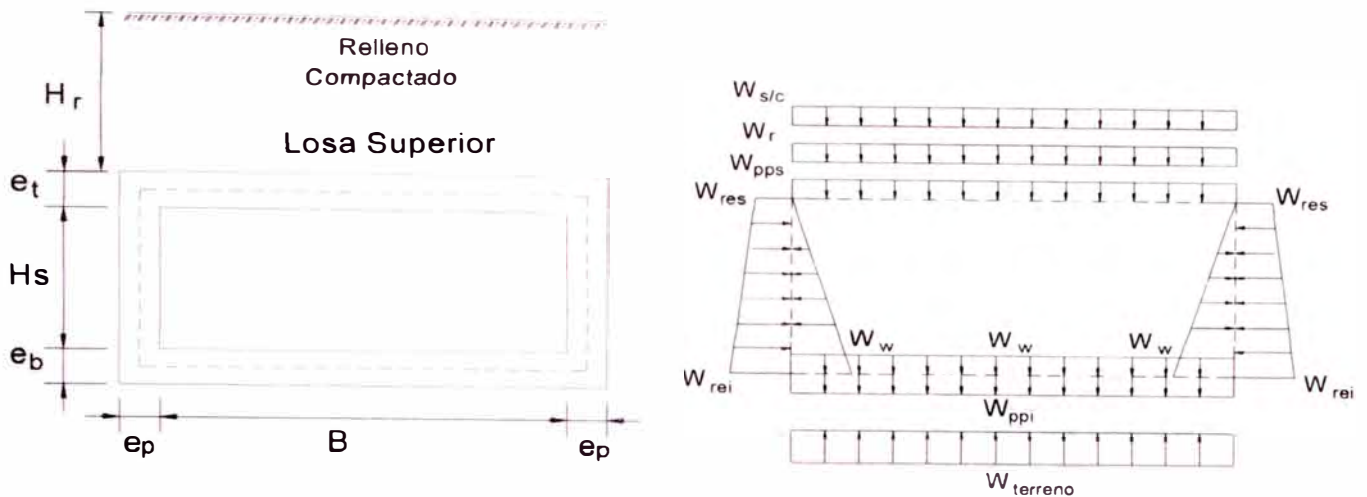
Cargas en Losa y Paredes de Alcantarilla Llena
